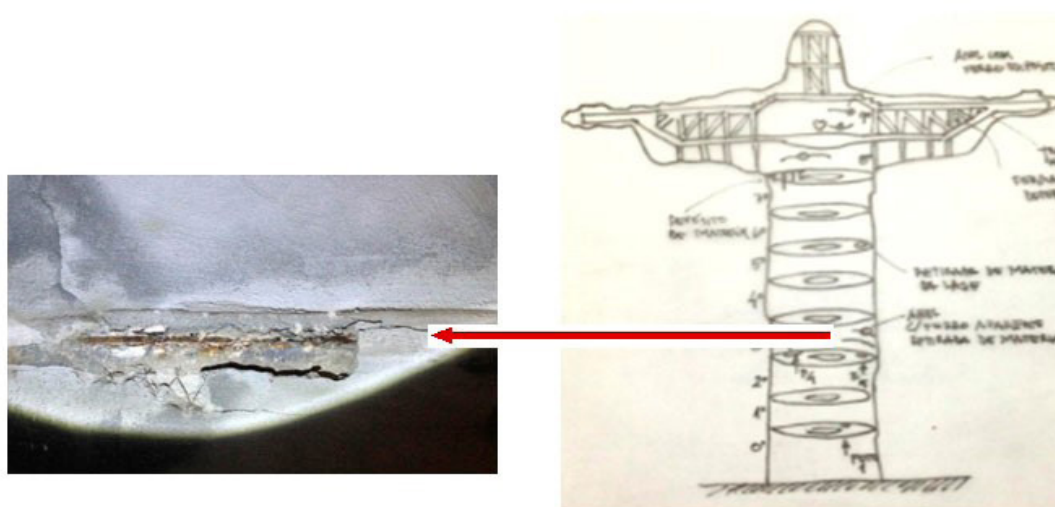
Vista interna, detalhe do desprendimento da argamassa com vergalhão oxidado que forma o gabarito em malha de aço para a estrutura externa e croqui com a localização do dano.
